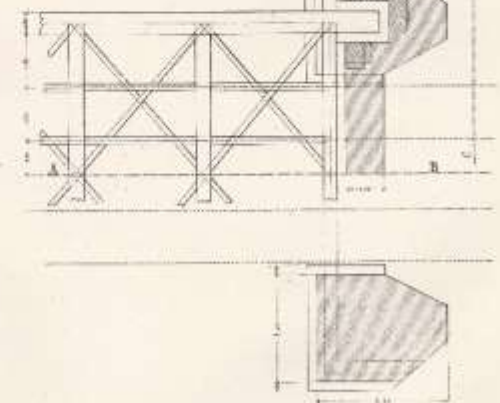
Plan et fondation d'une culée à 0 01 p^m
